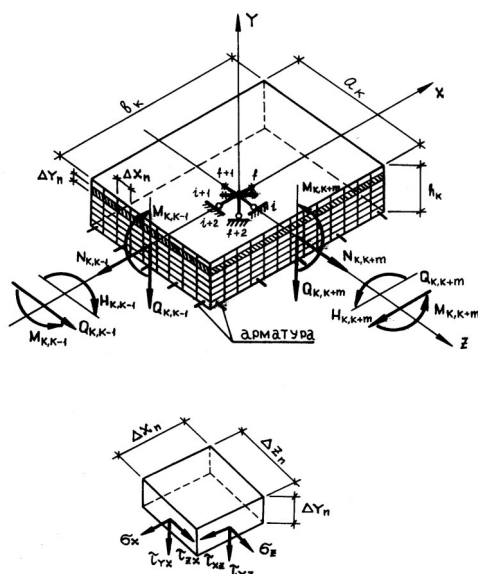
Расчетная схема по МСД для железобетонной плиты
